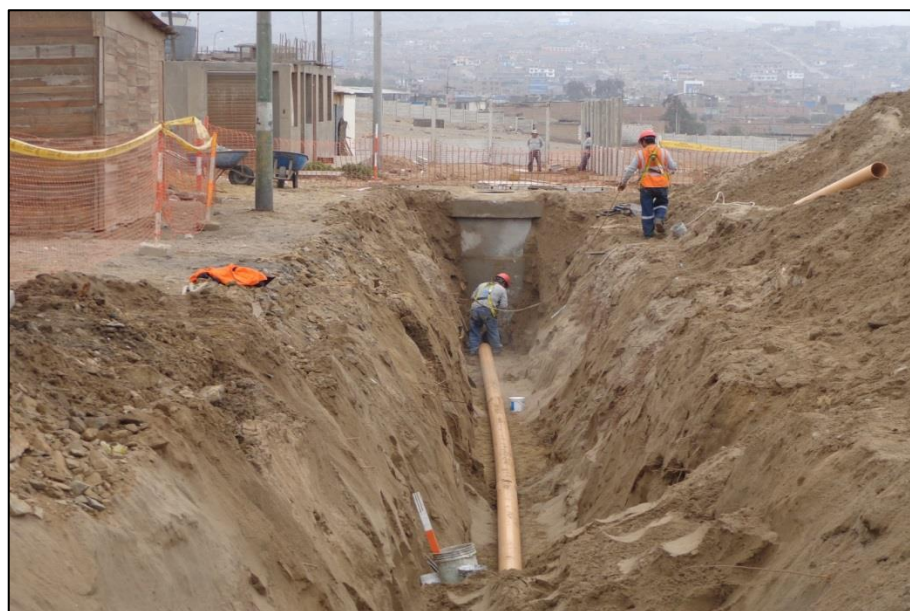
Culminación de excavación tipo III en red de alcantarillado (TIII-001).
